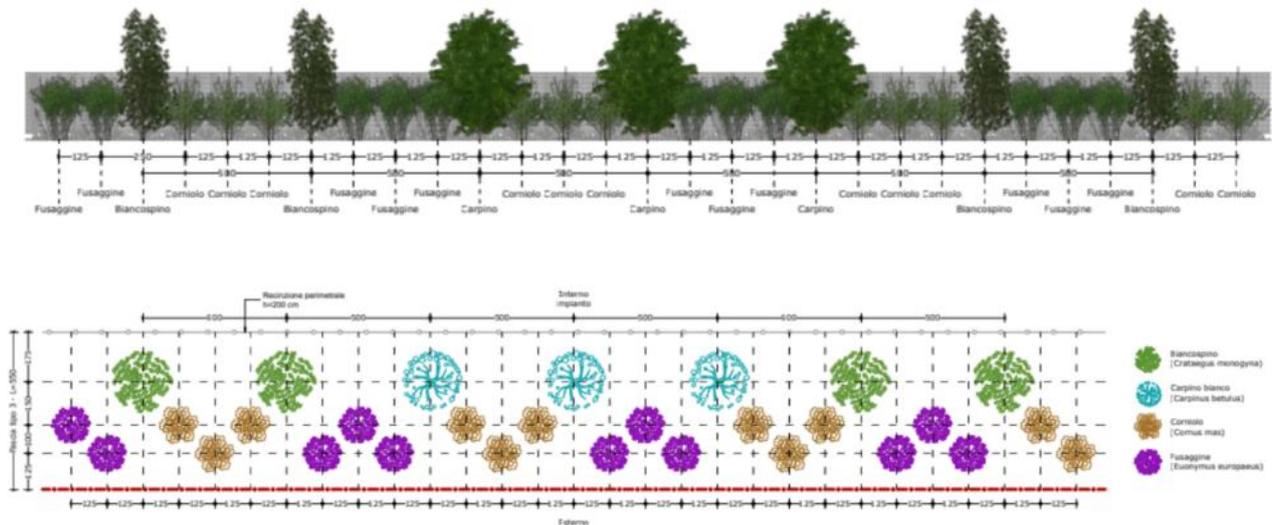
Pianta e prospetto della mitigazione di tipo 3 (da elab. di progetto)
